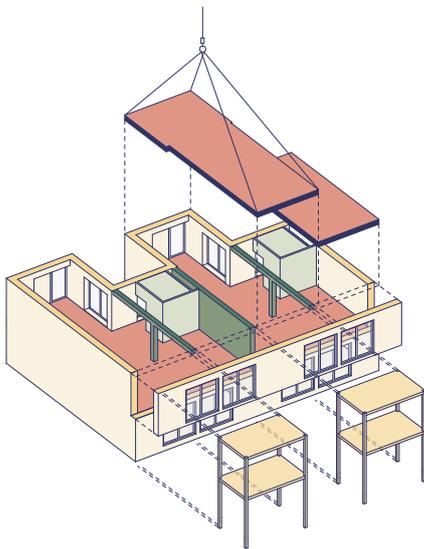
360 – Wiener Grundrissmodul.
